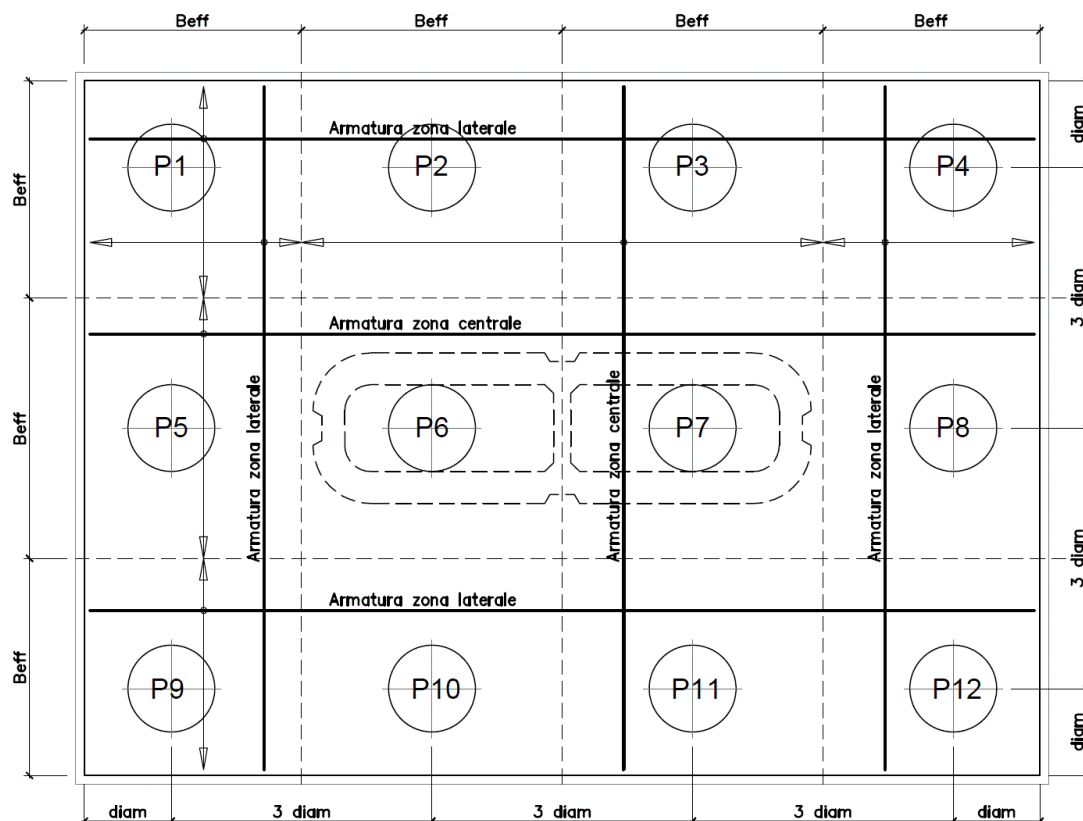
Plinto di fondazione – Armatura longitudinale inferiore e superiore
